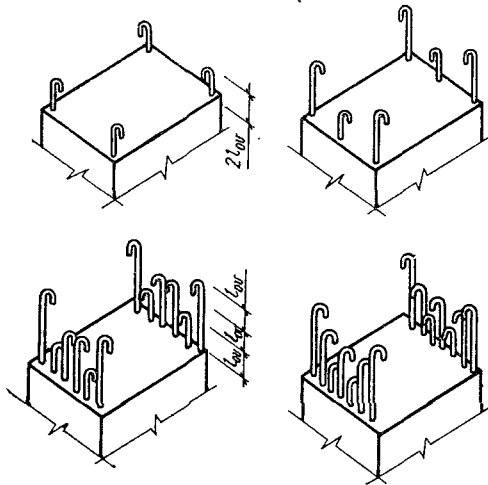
Расположение выпусков стержней периодического профиля для устройства стыков арматуры фундамента с арматурой колонны внахлестку без сварки.
